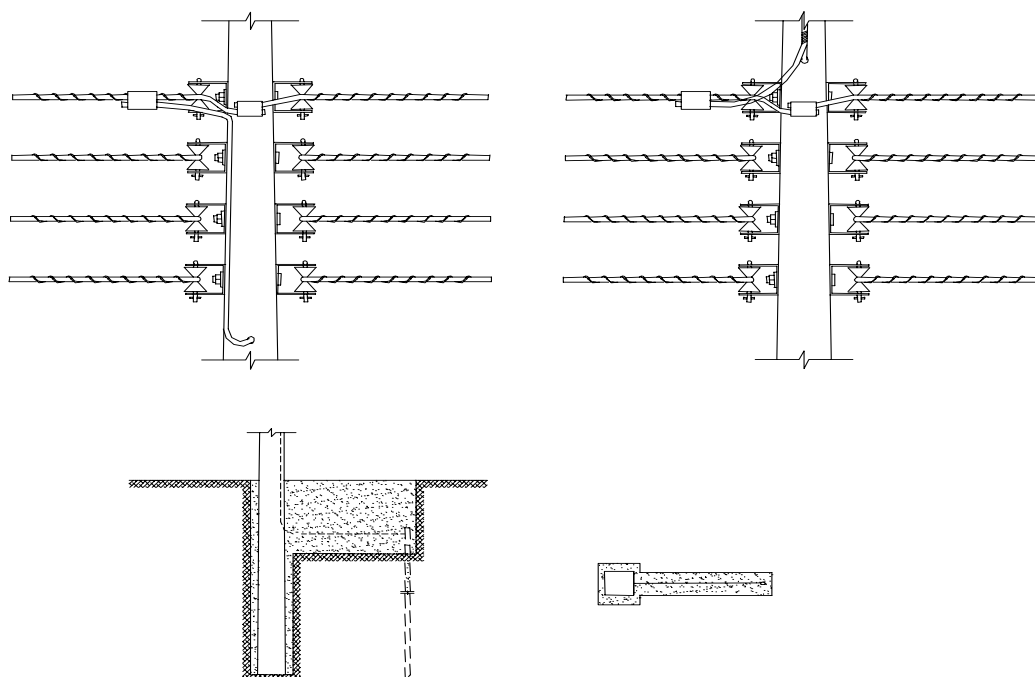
Aterramento de rede secundária (estrutura de seccionamento ou fim de rede)
